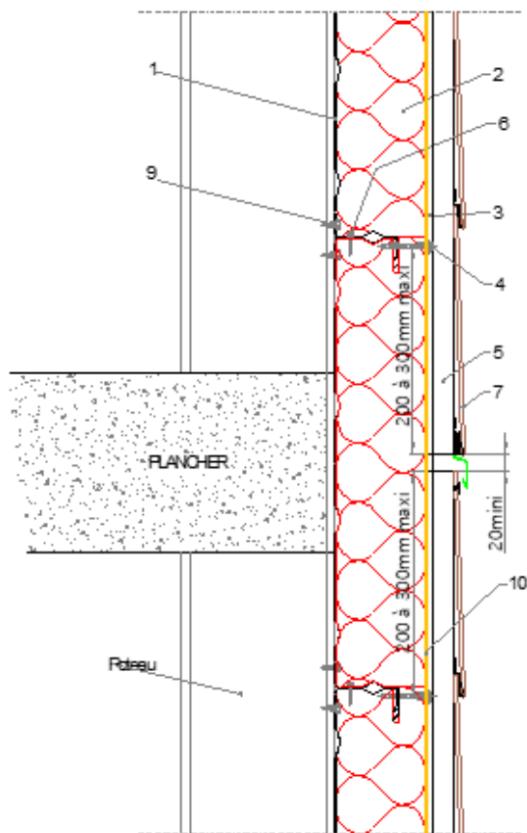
bis – Fractionnement d'ossature – Coupe verticale
